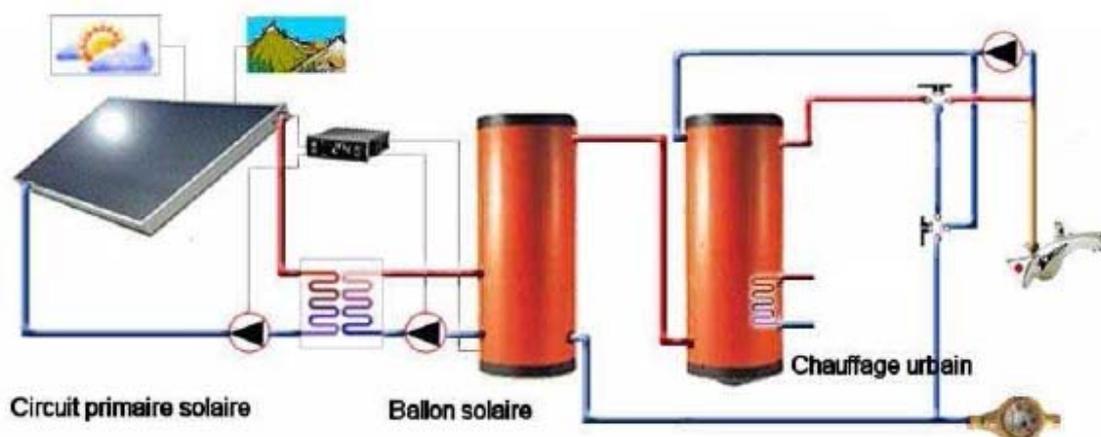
Schéma de fonctionnement du dispositif de chauffage de l'ECS par panneaux solaires
